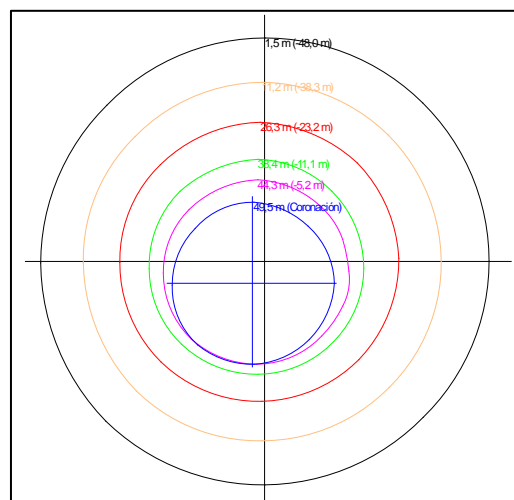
Vista en planta de las seis secciones básicas analizadas.
